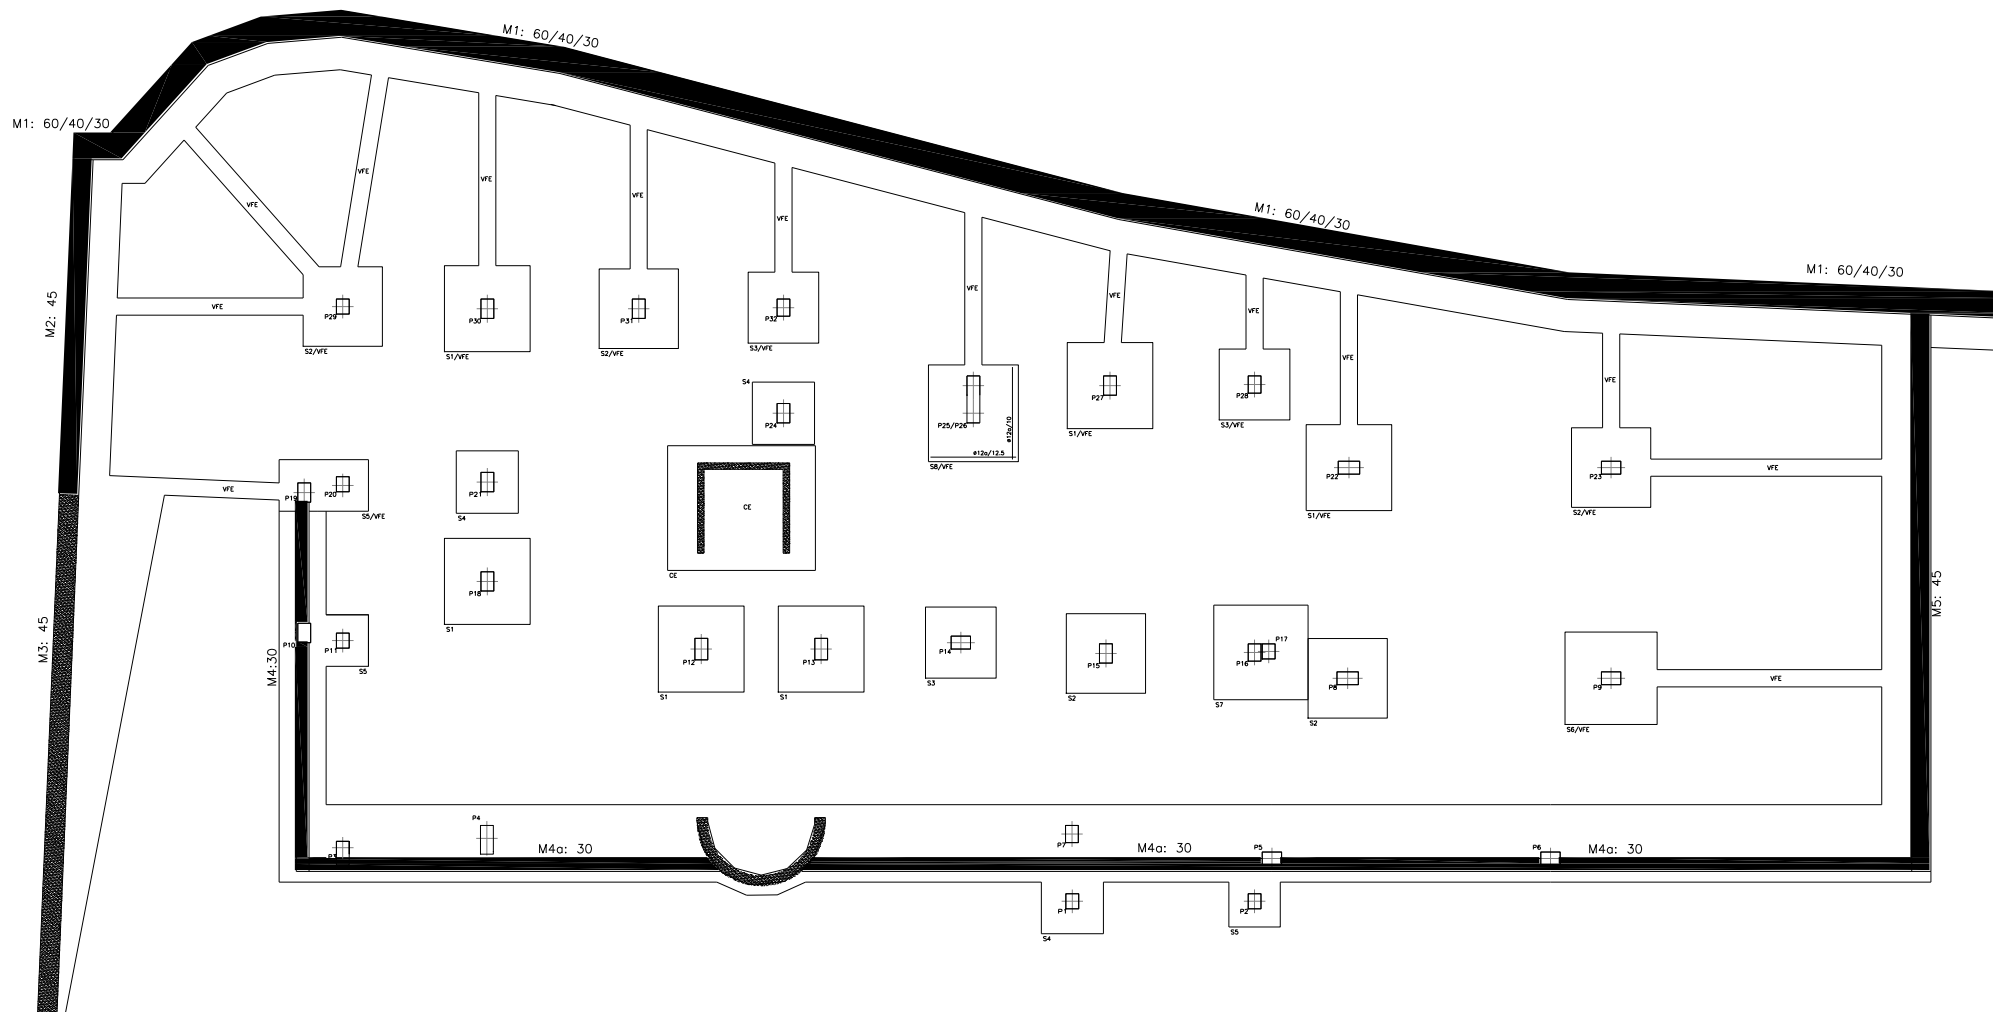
Planta de fundações e vigas de fundações, (sem escala)
